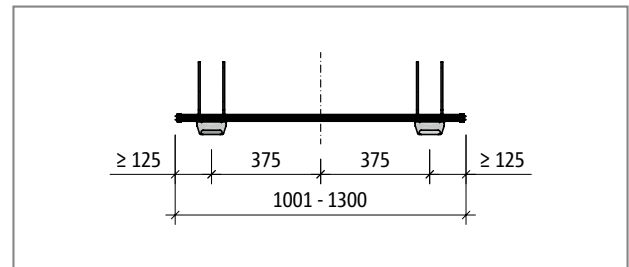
Schöck Tronsole® Typ T-V2-H...-L1001 bis L1300: Produktgrundriss
